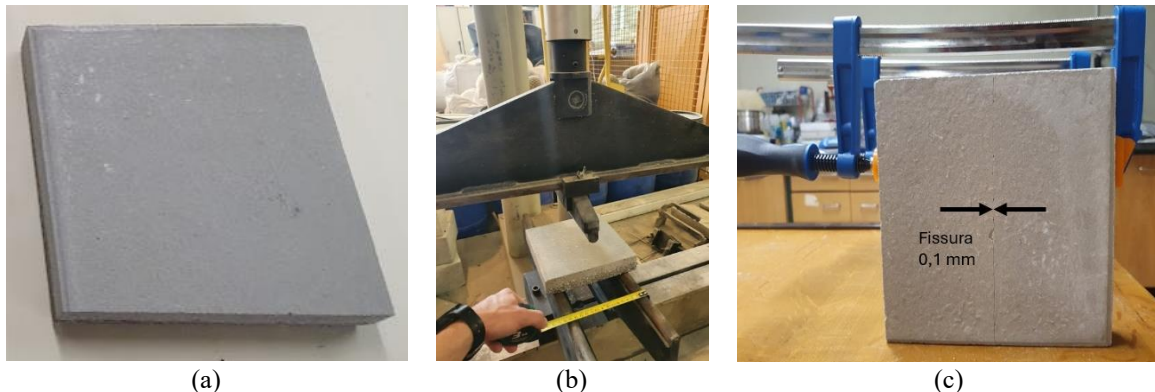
Criação das fissuras nas lajetas pré-fabricadas: a) lajeta quadrada antes do ensaio de flexão; b) ensaio de flexão até à rotura; c) lajeta fissurada ao meio, mantida estável com um grampo.
